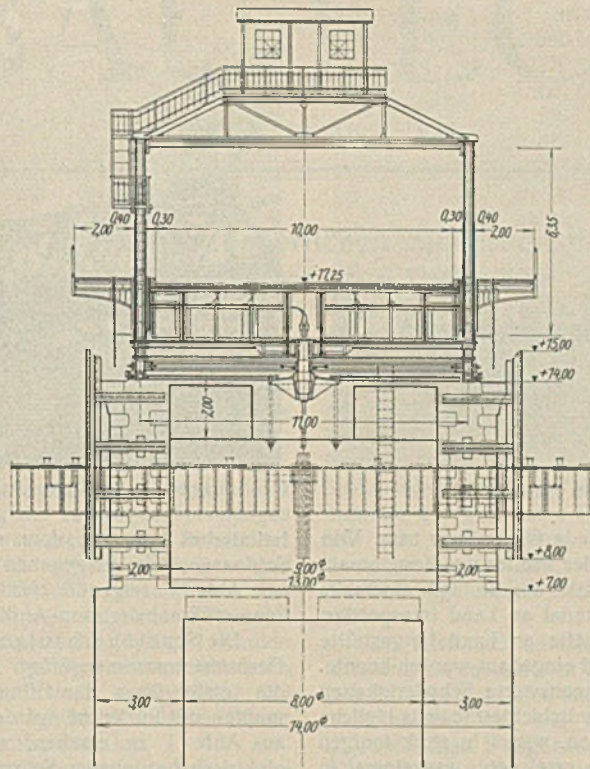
Drehbrücke mit Antriebsvorrichtung (Querschnitt).
